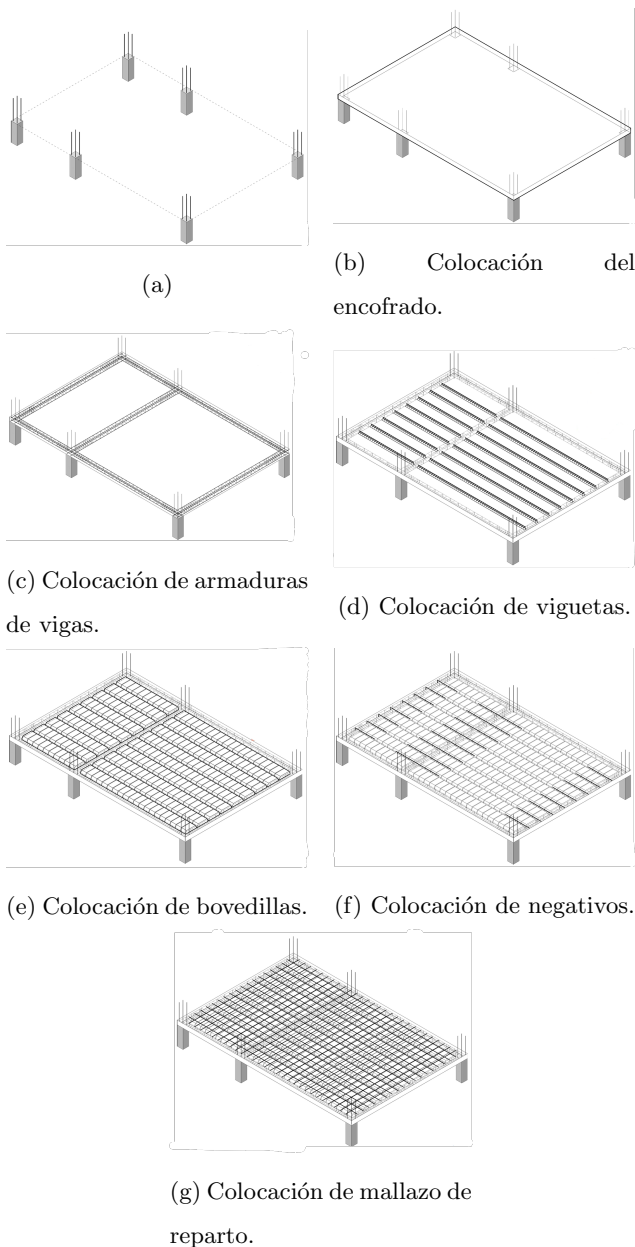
Proceso Constructivo de Forjados Unidireccionales de Viguetas.
